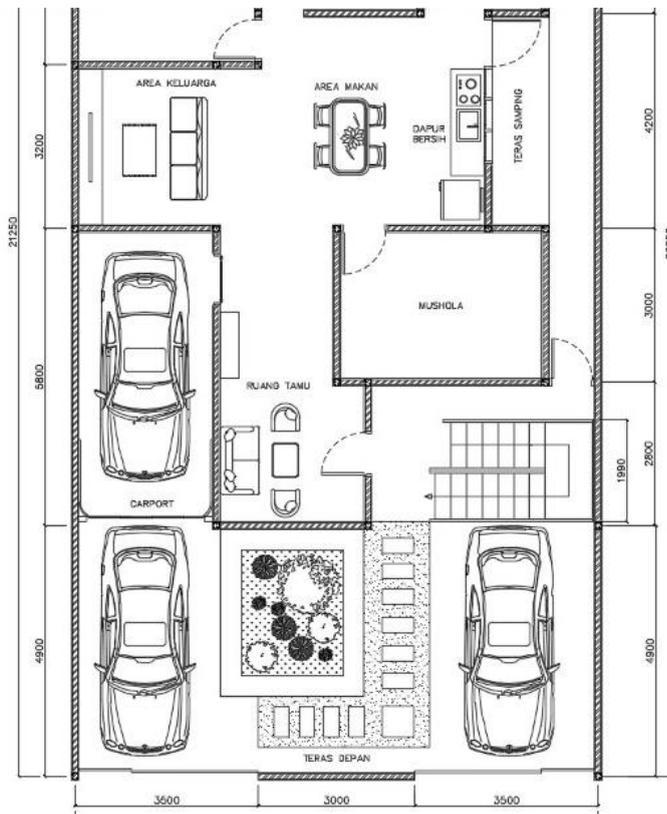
Denah overall lantai 1&2 Euphorbia
